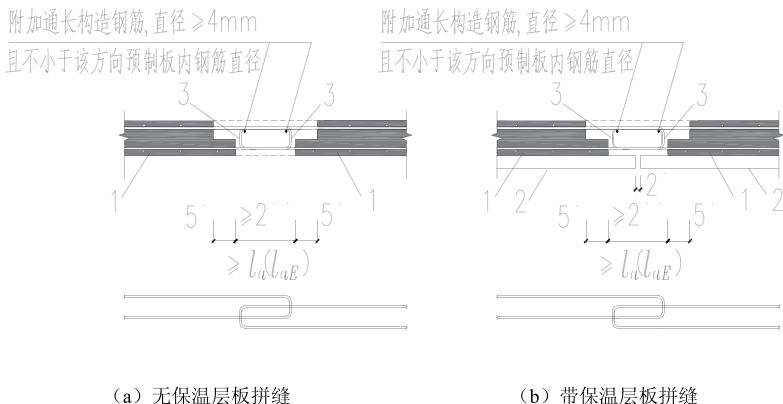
变阶预制混凝土双向板拼缝构造示意图
